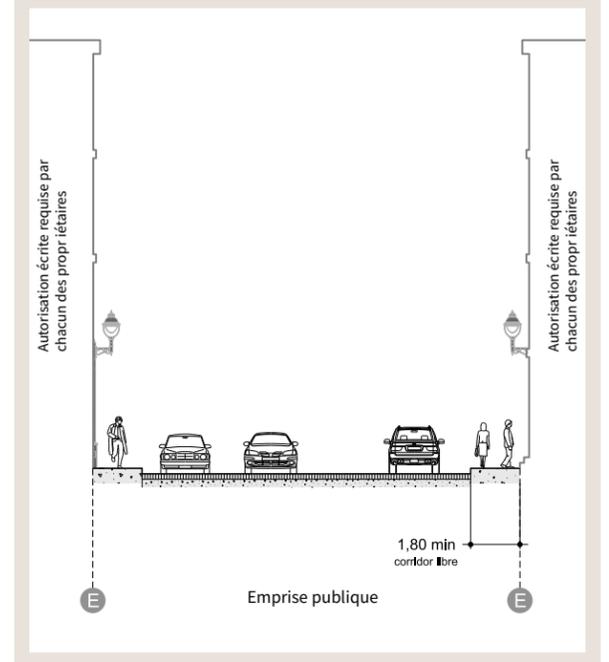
CROQUIS DE LAMPADAIRES FIXÉS À LA FAÇADE DES BÂTIMENTS
